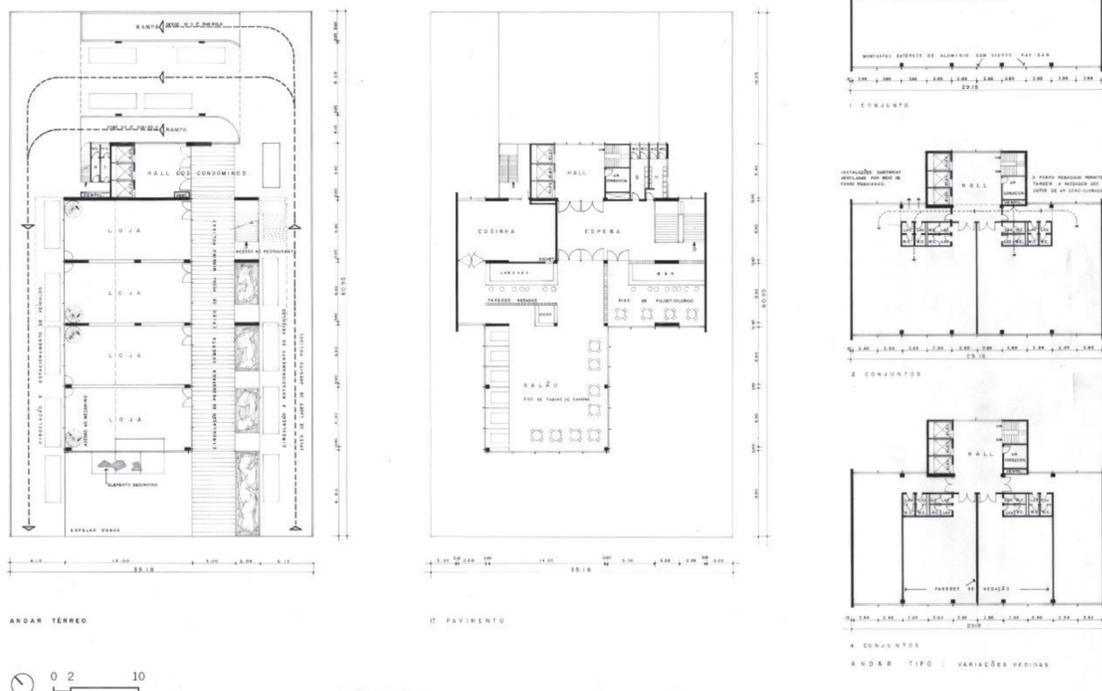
Plantas do térreo inferior, térreo superior e pavimento tipo, Pedro Paulo de Melo Saraiva
